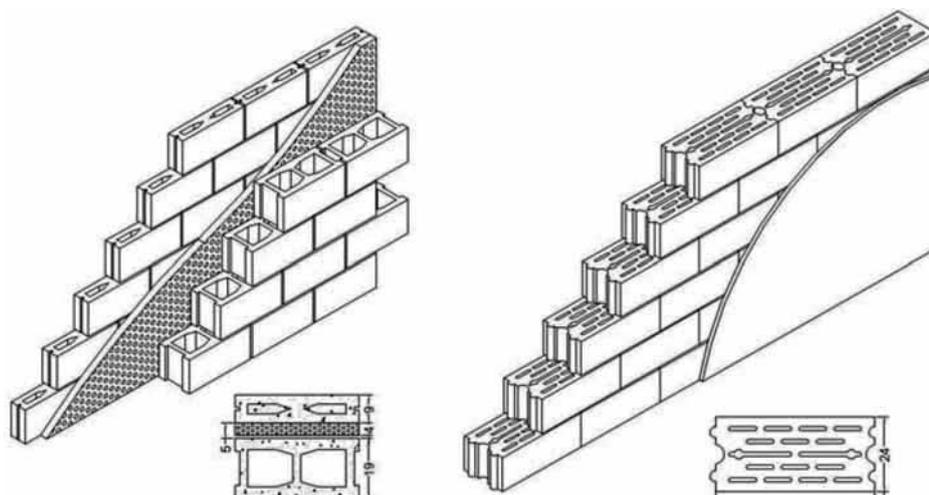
[Izquierda]: Muro de 2 hojas de bloque de hormigón + 4cm aislamiento. [Derecha]: Muro de 1 hoja de bloque aligerado.
